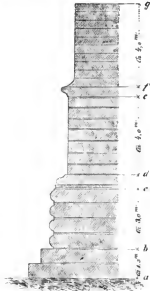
Schnitt nach m. n. des Grundrisses auf S. 187.
